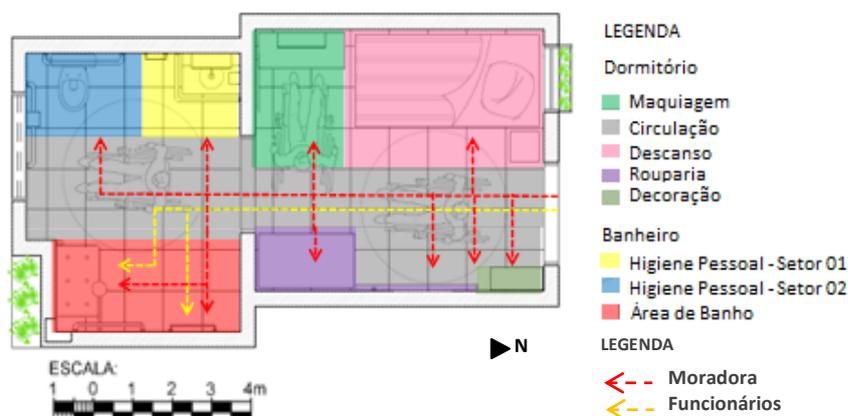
Planta baixa de reforma suíte nº 4 - Anteprojeto
